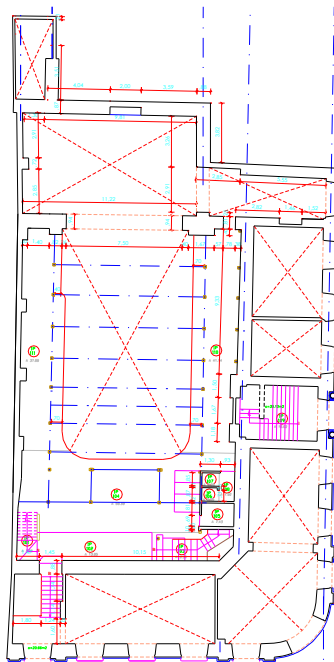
Planta arquitectónica primer palco – primer piso alto
